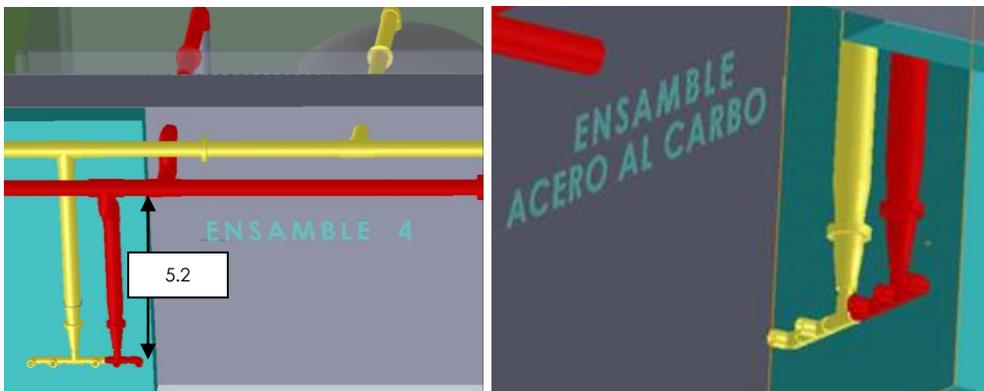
Numero de tomas por bajada de acuerdo al área de soldadura.
